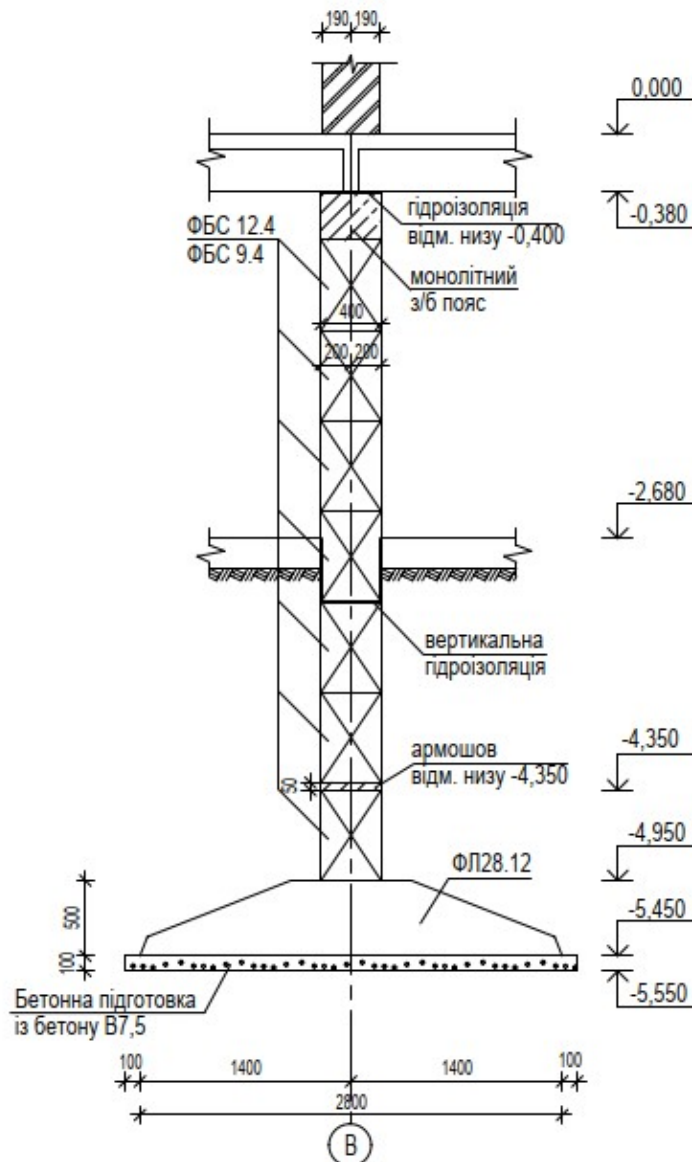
Конструктивне рішення стрічкового фундаменту із збірних фундаментних плит та блоків
